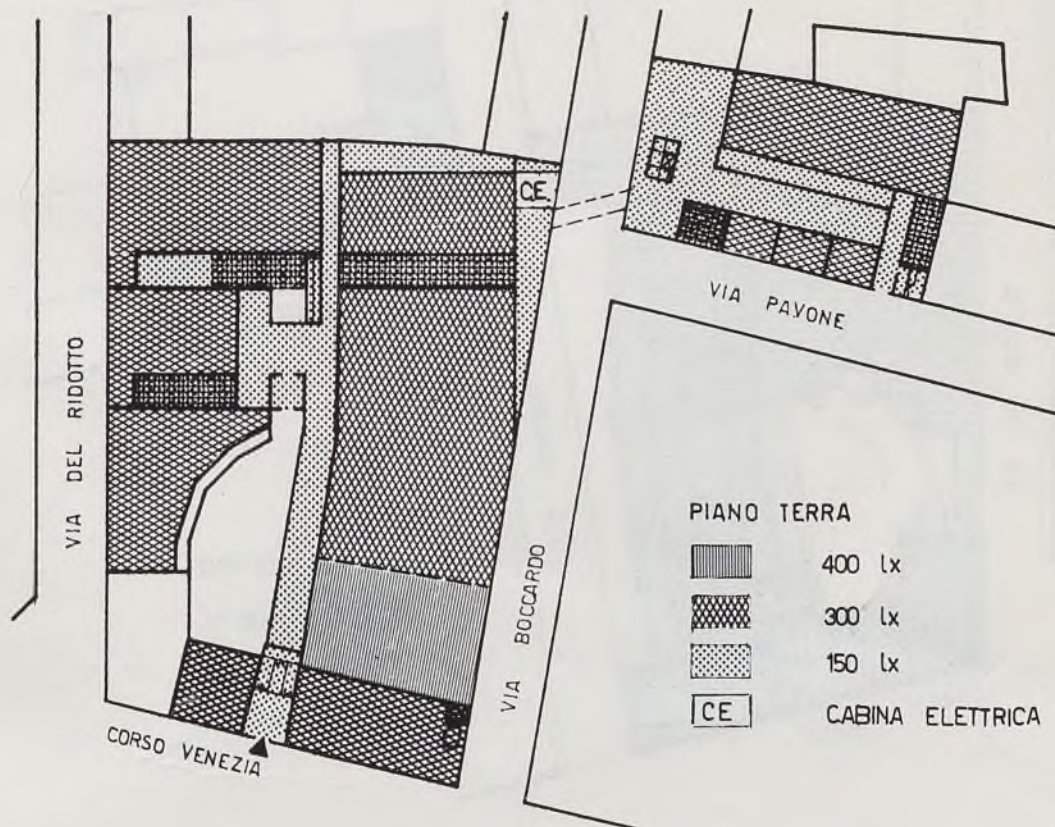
Illuminazione artificiale - Planimetria piano terreno.
